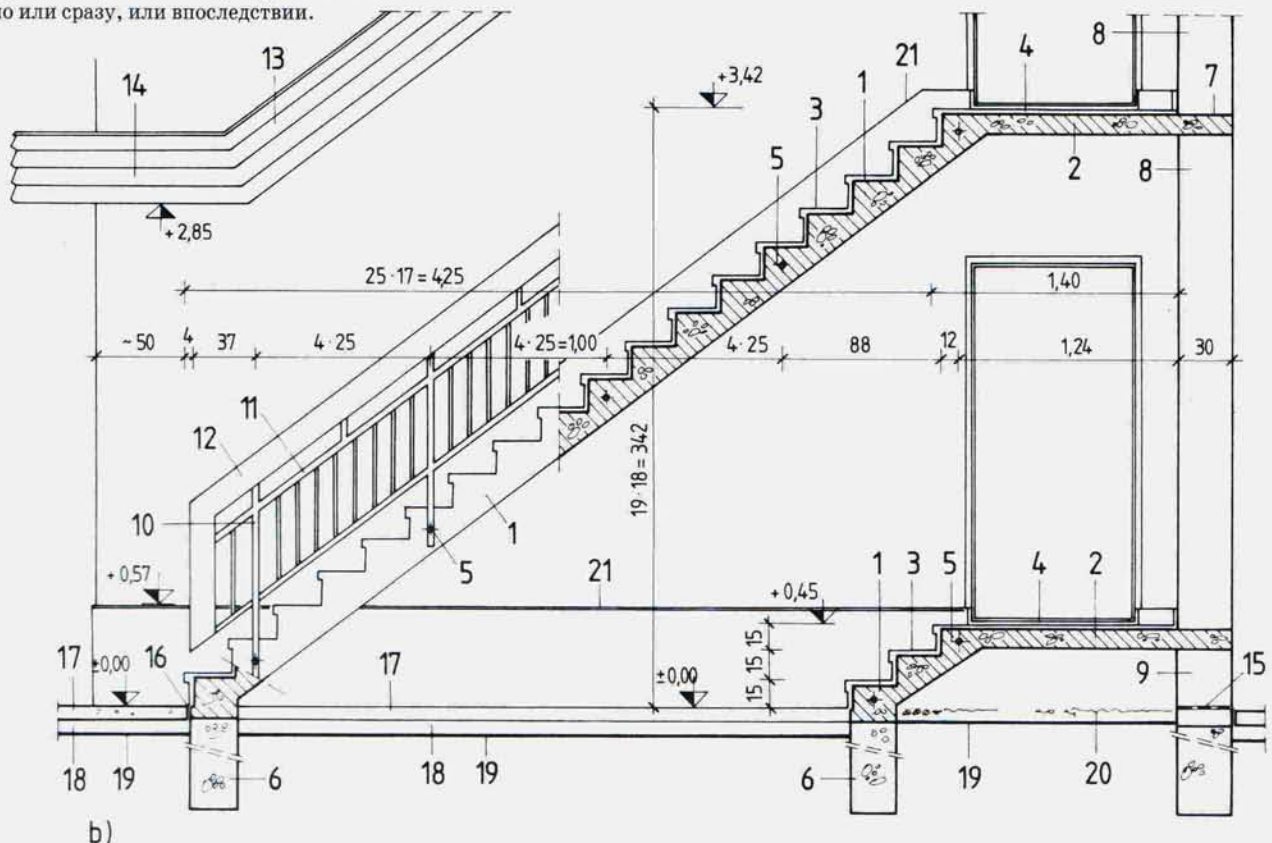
Наружная железобетонная лестница, ведущая в верхнее жилое помещение
